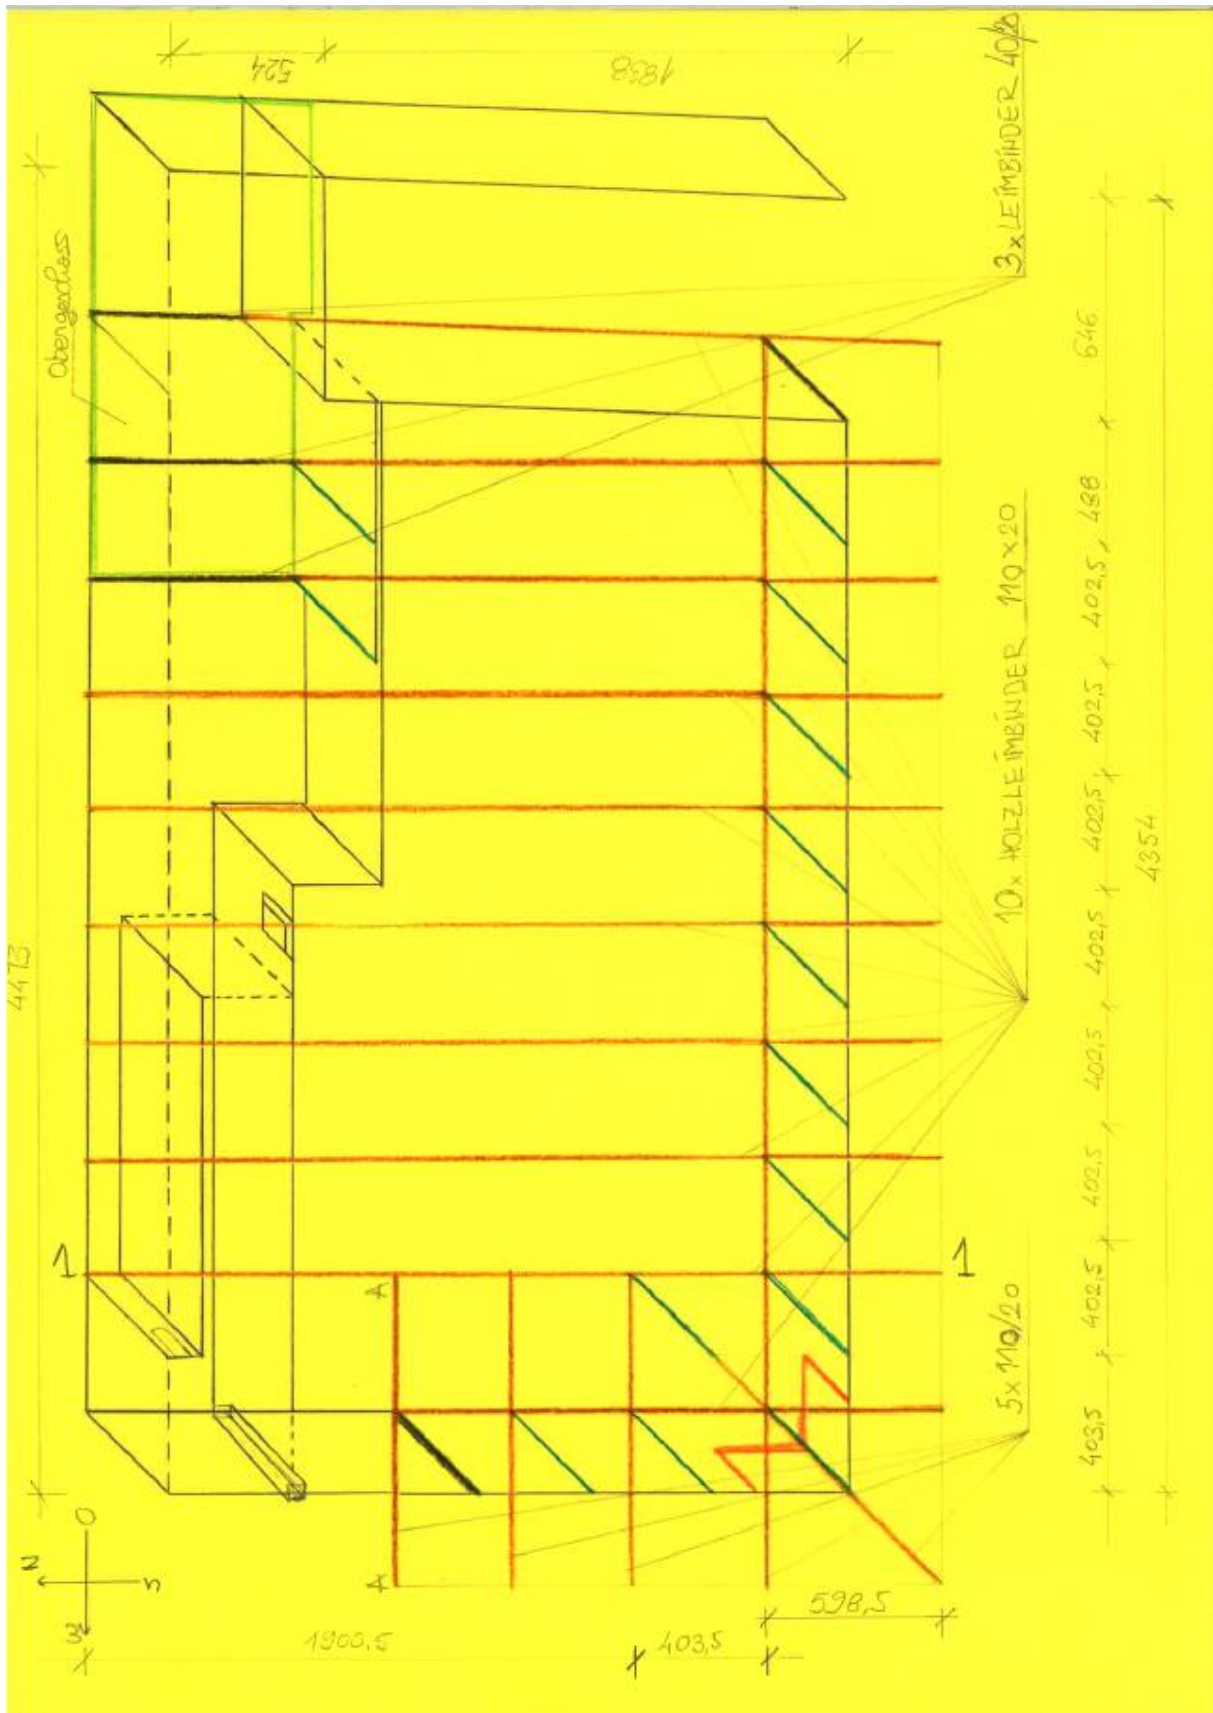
Konstruktion des Einkaufsmarktes, Grundriss, Kaindorf
